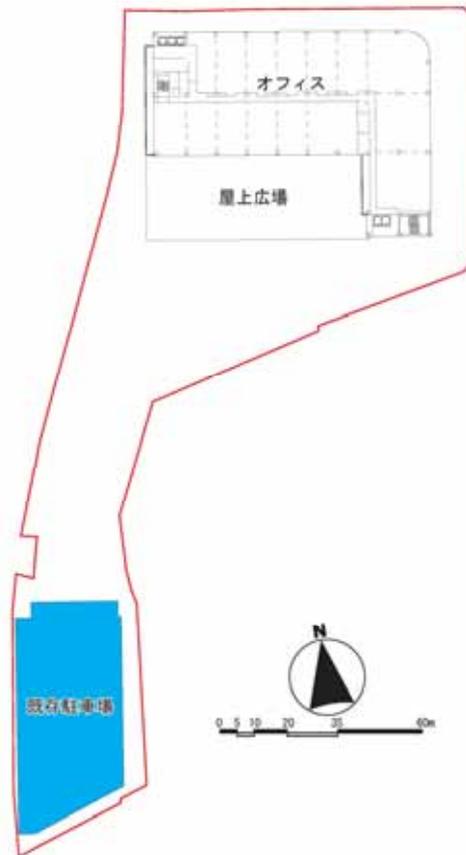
(10) 各階平面図 ( 10 ~ 12 F )
